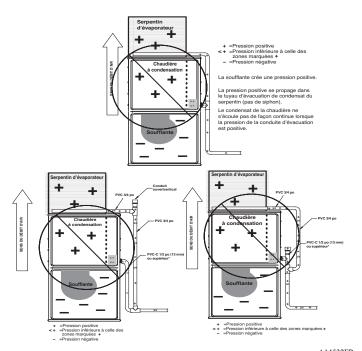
Exemple de fixation au tuyau d'évacuation sur place (non autorisé)
